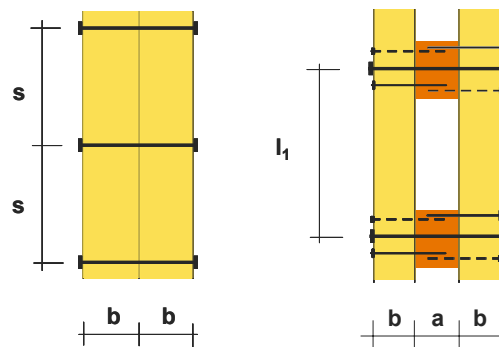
Poteaux reconstitués continus ou entretoisés
